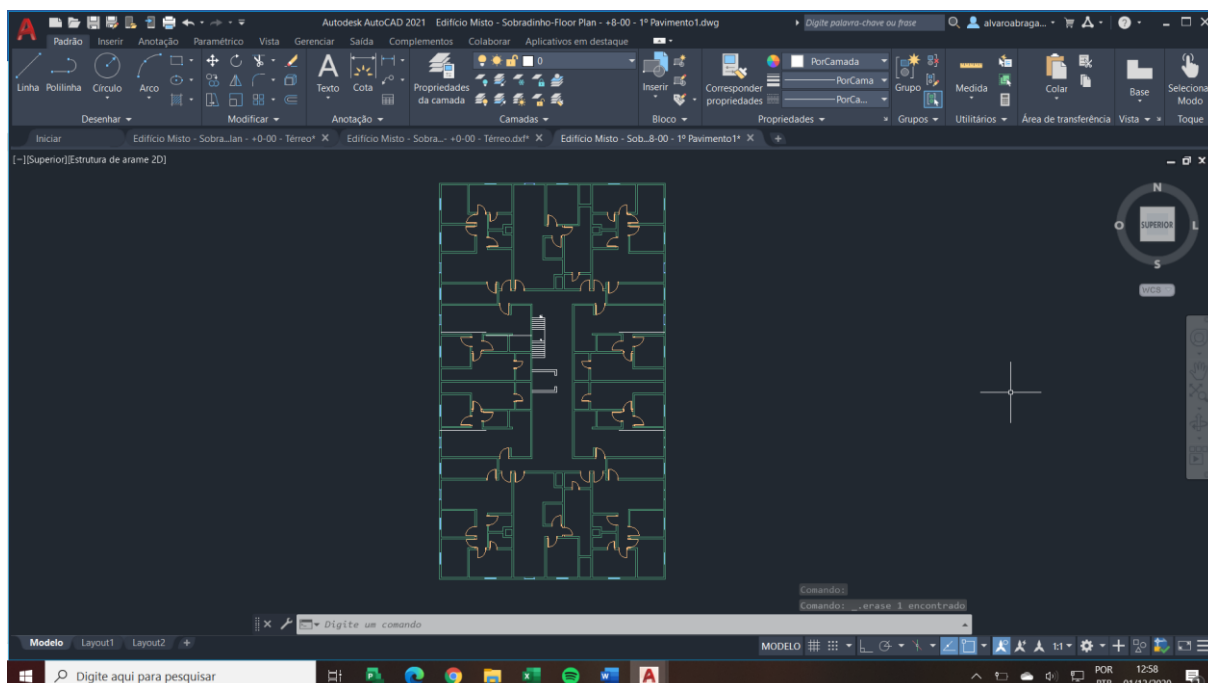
Planta baixa do pavimento tipo, em DWG. Realizado pelo autor.
